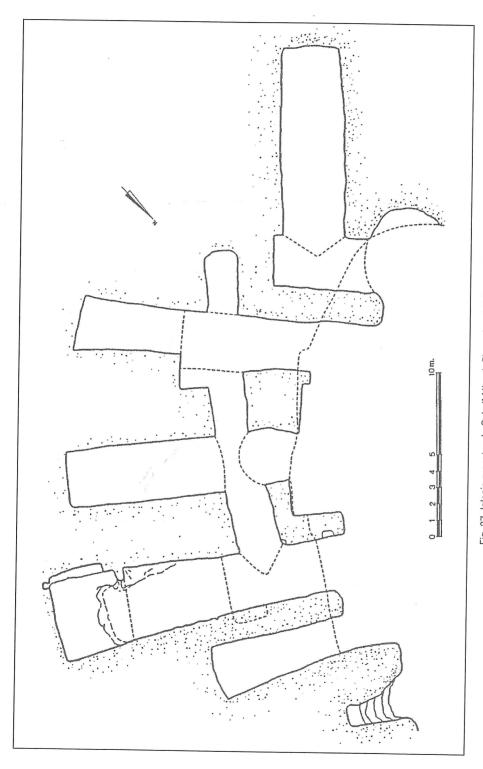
Iglesia rupestre de Coín (Málaga). Planta (según: Puertas Tricas)
